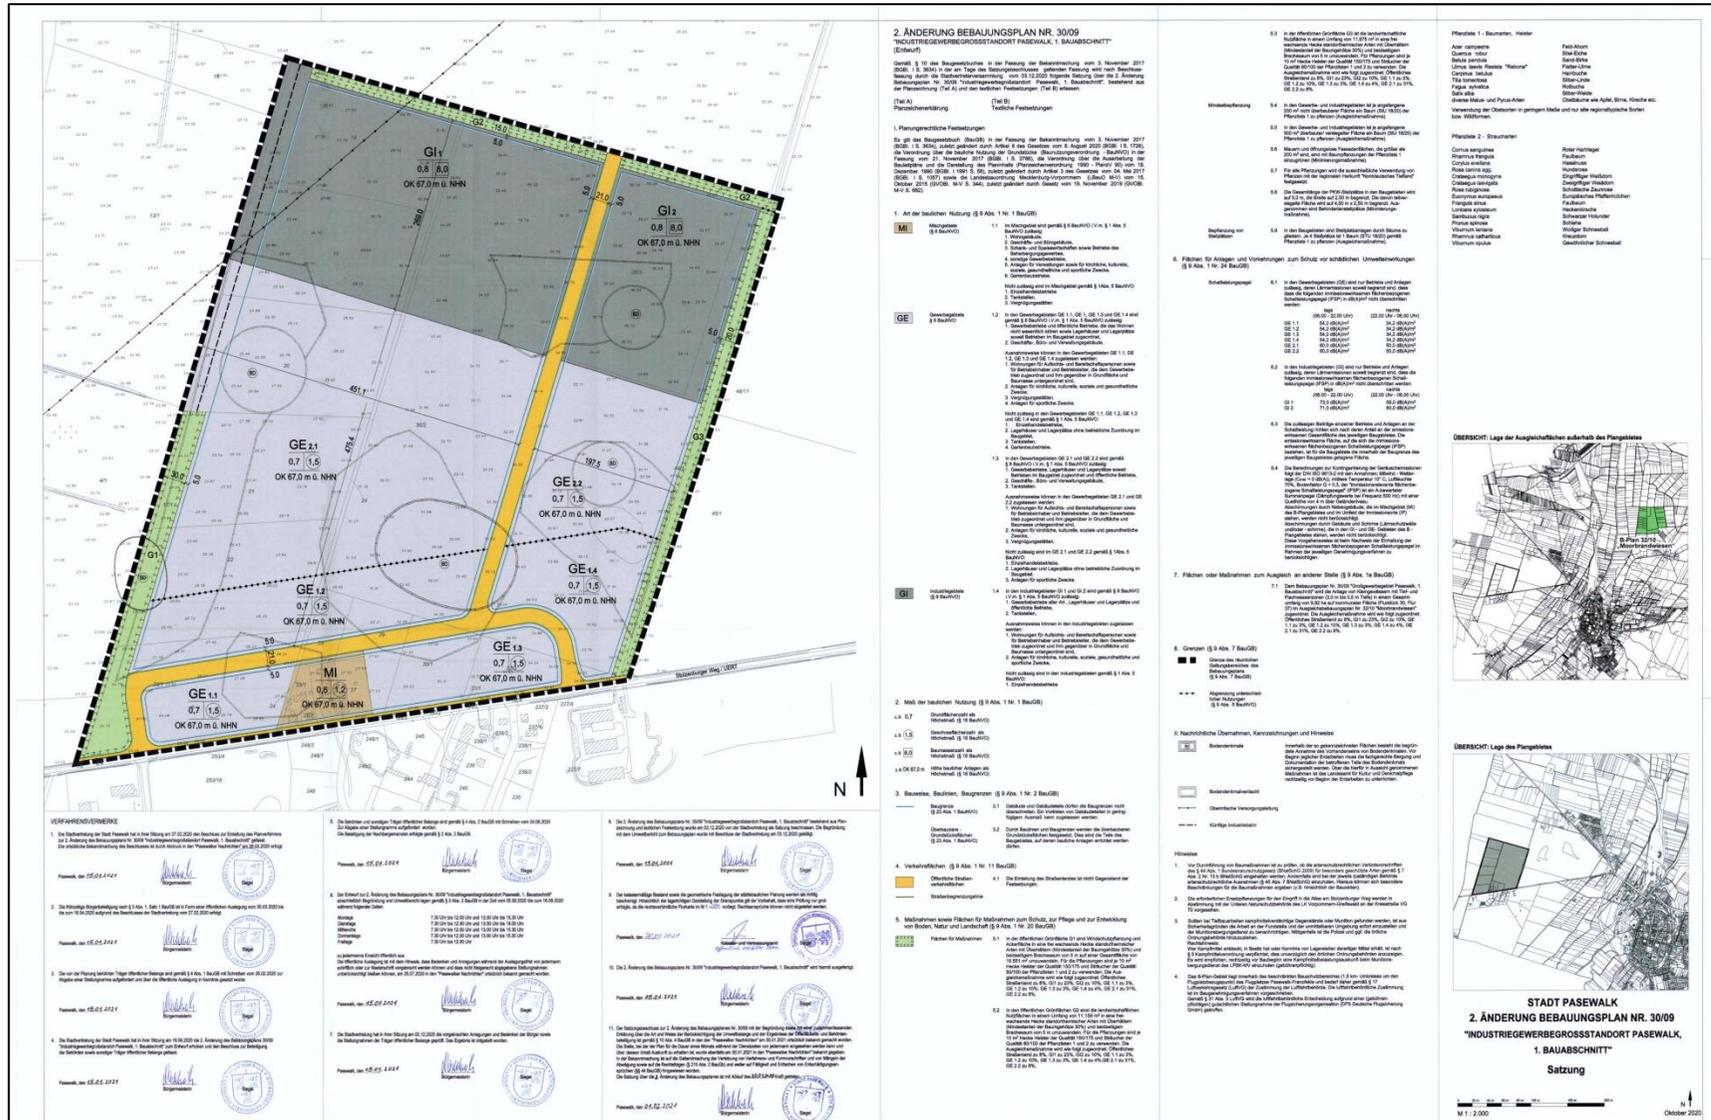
Planzeichnung 2. Änderung B – Plan 30/09 (/6)
